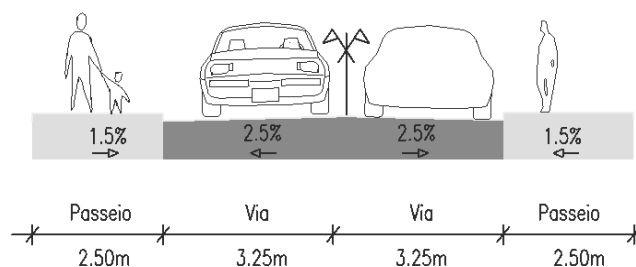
Perfil Transversal Tipo 6 – Eixos 5.2, 5.3 e 9
